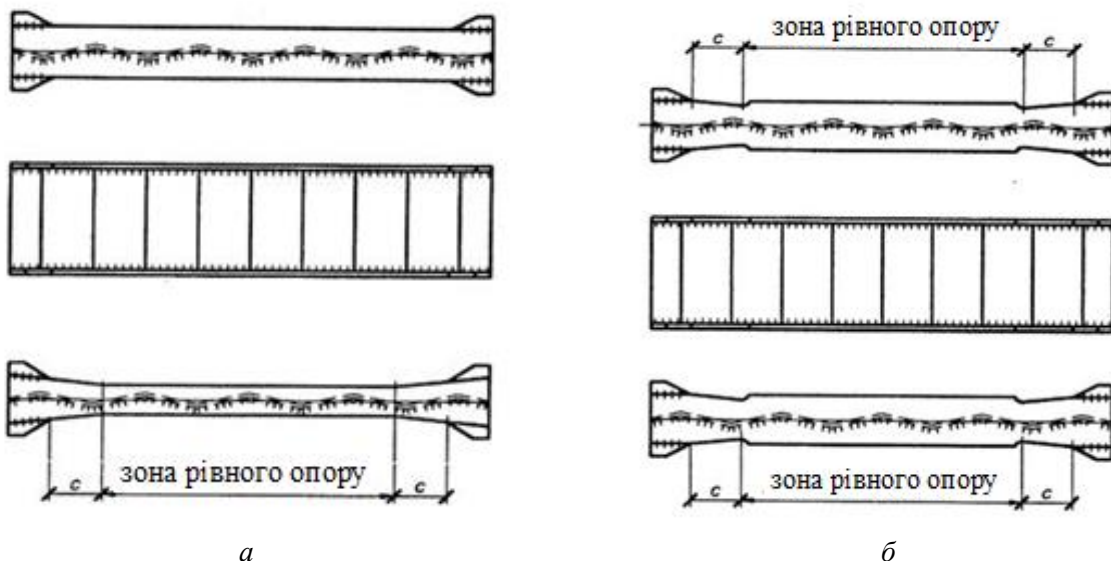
Сталеві ригелі з поперечно-гофрованими стінками сейсмостійких каркасних будівель:
